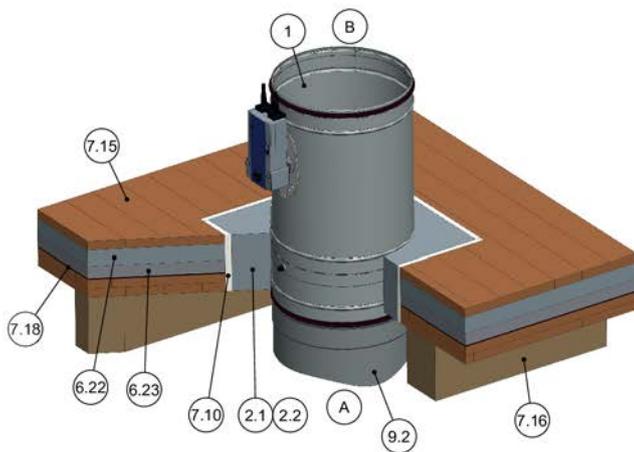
Montagem seca com kit de montagem TQ em teto de vigas de madeira/de vigas laminadas, suspensa (ilustração representativa, estrutura de teto alternativa possível mediante pedido)
